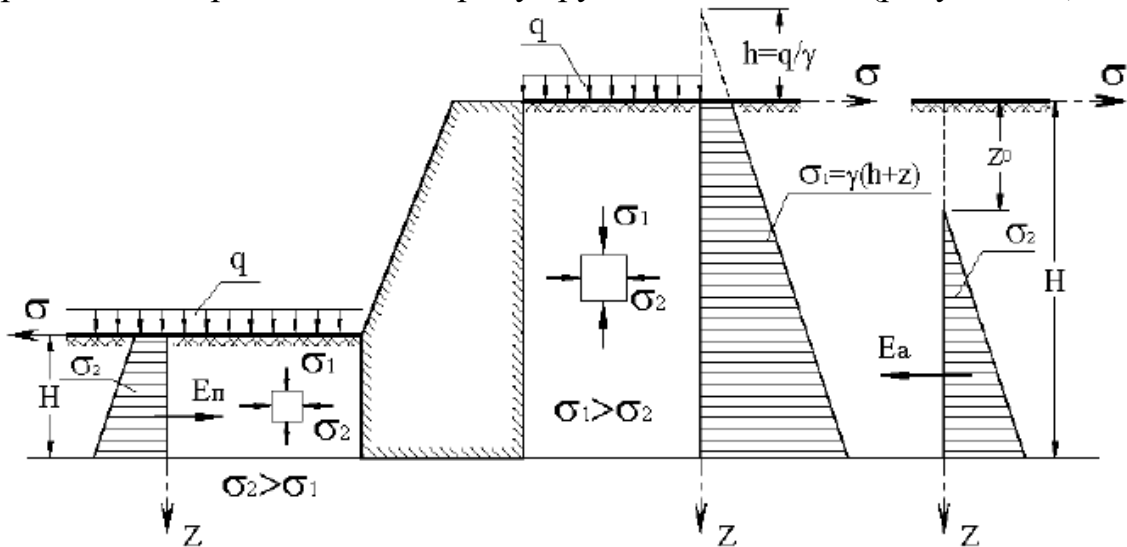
Расчетная схема к определению давления грунта на подпорную стену
